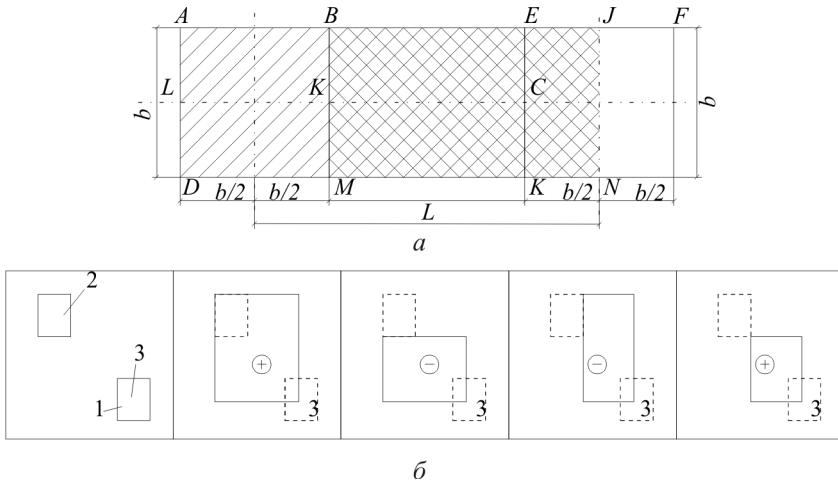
Схема взаємного розміщення фундаменту, що проектується, та фундаменту, що впливає на нього: a – взаємний вплив фундаменту, що проектується та наявного фундаменту, b – варіанти розміщення фундаментів; 1 – фундамент, що проектується; 2 – фундамент, що впливає; 3 – точка, в якій визначається осідання
